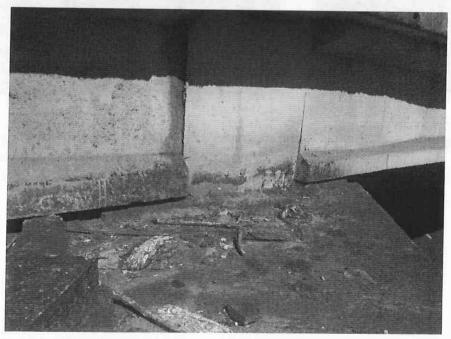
Detalhe da posição central, existe uma alvenaria entre as vigas.
